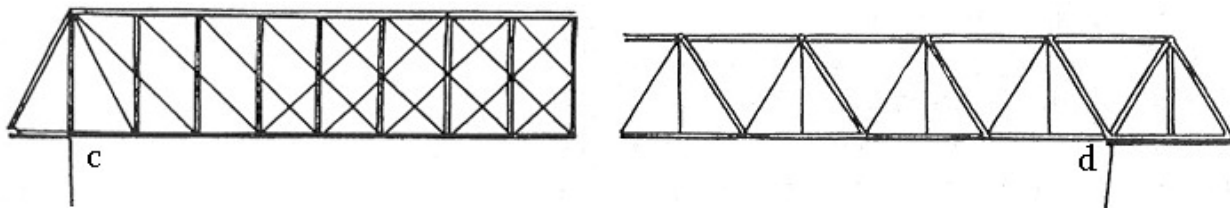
Izquierda (c) armadura tipo Whipple; derecha (d) armadura tipo Warren. Fuente: Rowland Mainstone, *Developments in structural form*.
